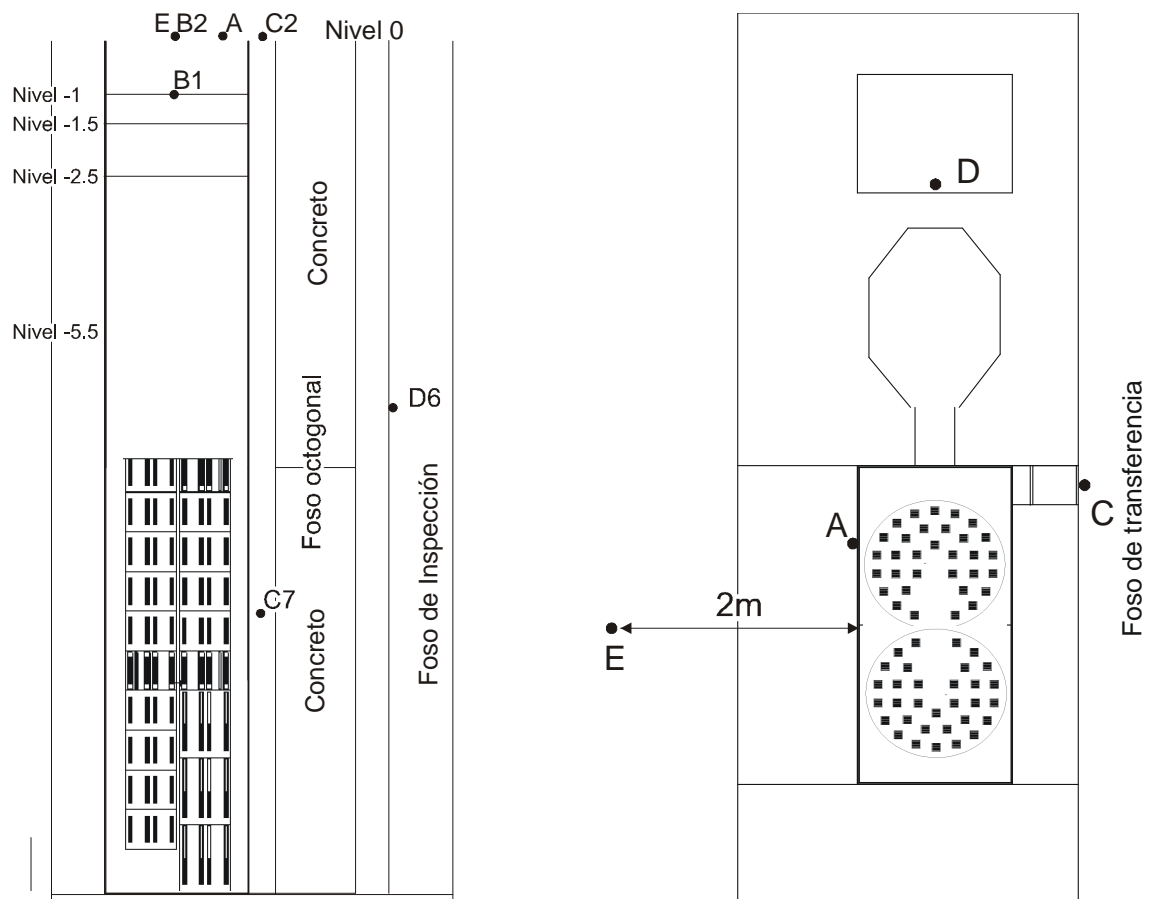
Corte transversal y vista en planta de la pileta de almacenamiento y octógono, con la ubicación de los puntos a calcular tasa de dosis
